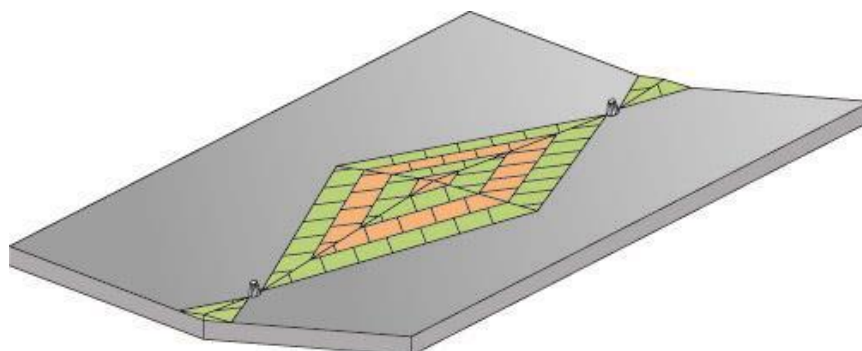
Пример раскладки плит при создании уклона между воронками
